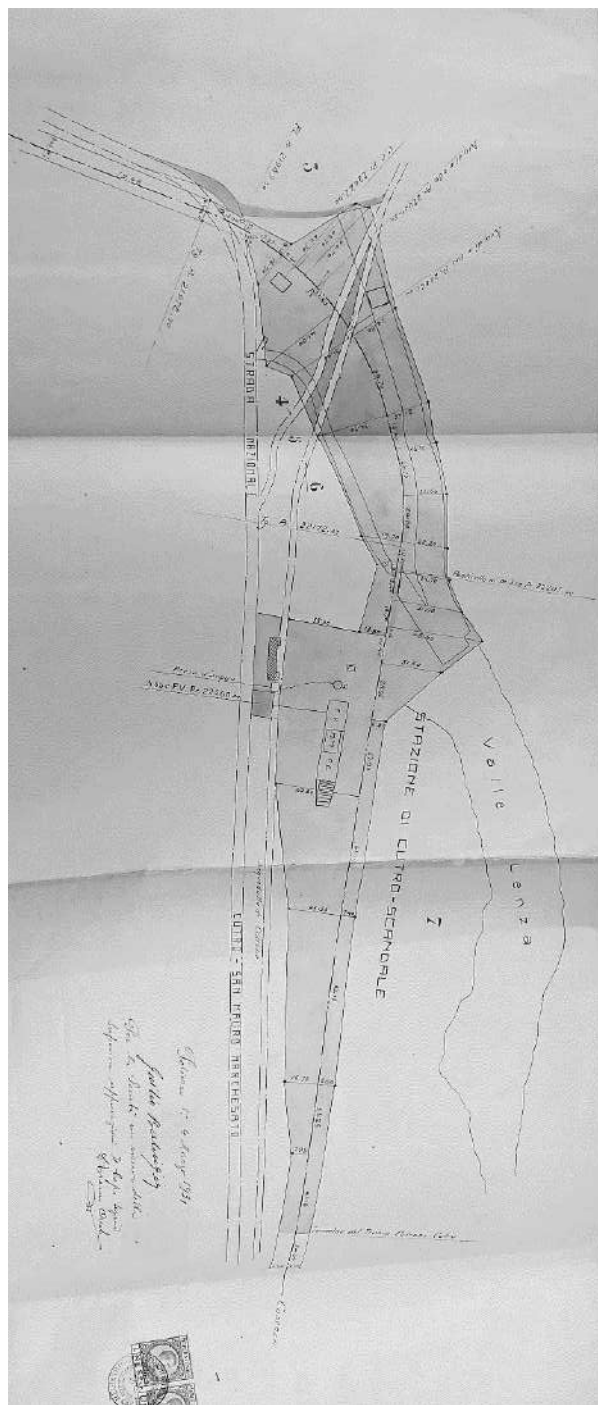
Piano di esecuzione di esproprio, Stazione di Cutro-Scandale
